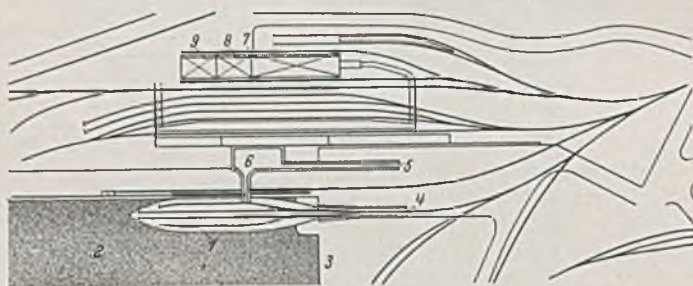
Lageplan der Landungseinrichtungen in Dünkirchen mit Bahnhof.
